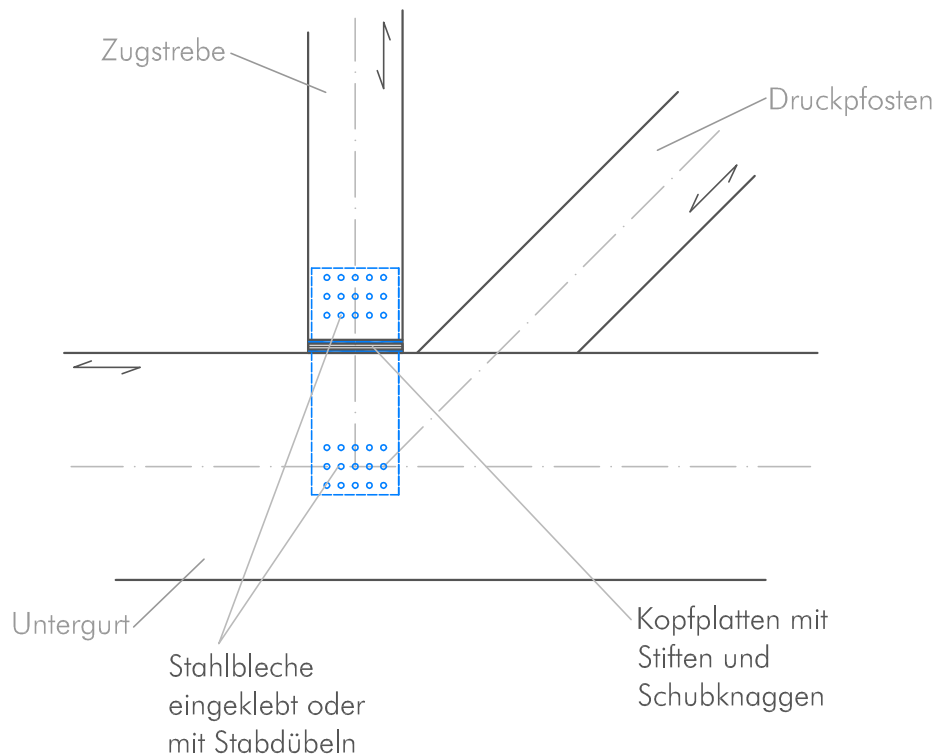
Anschlusslösung für Fachwerkknoten mit eingeklebten Stahlblechen und Schubknaggen zur Lastübertragung
